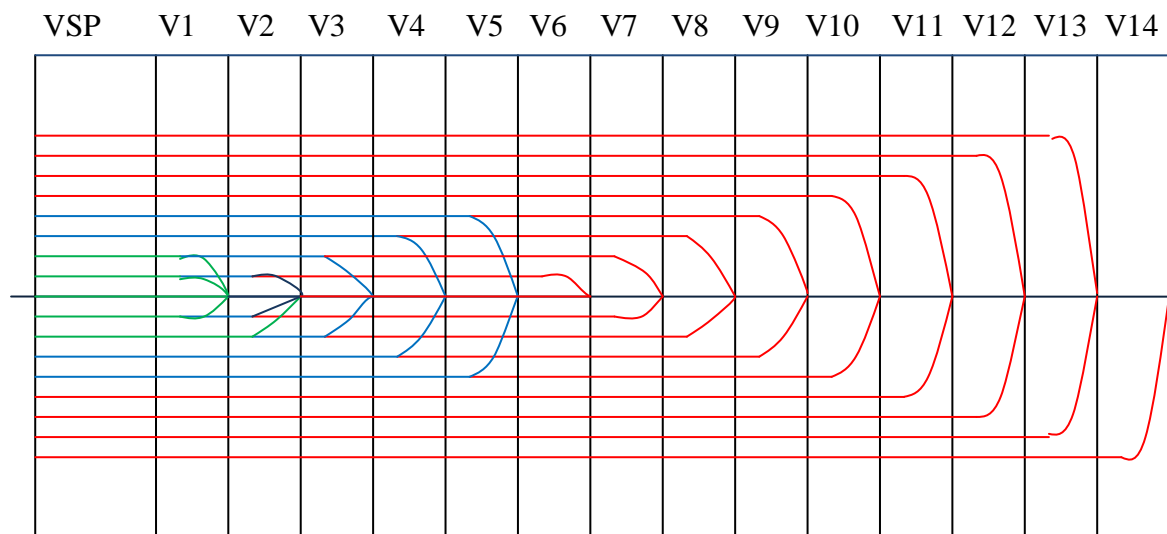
Tracé en plan des câbles de fléau.
